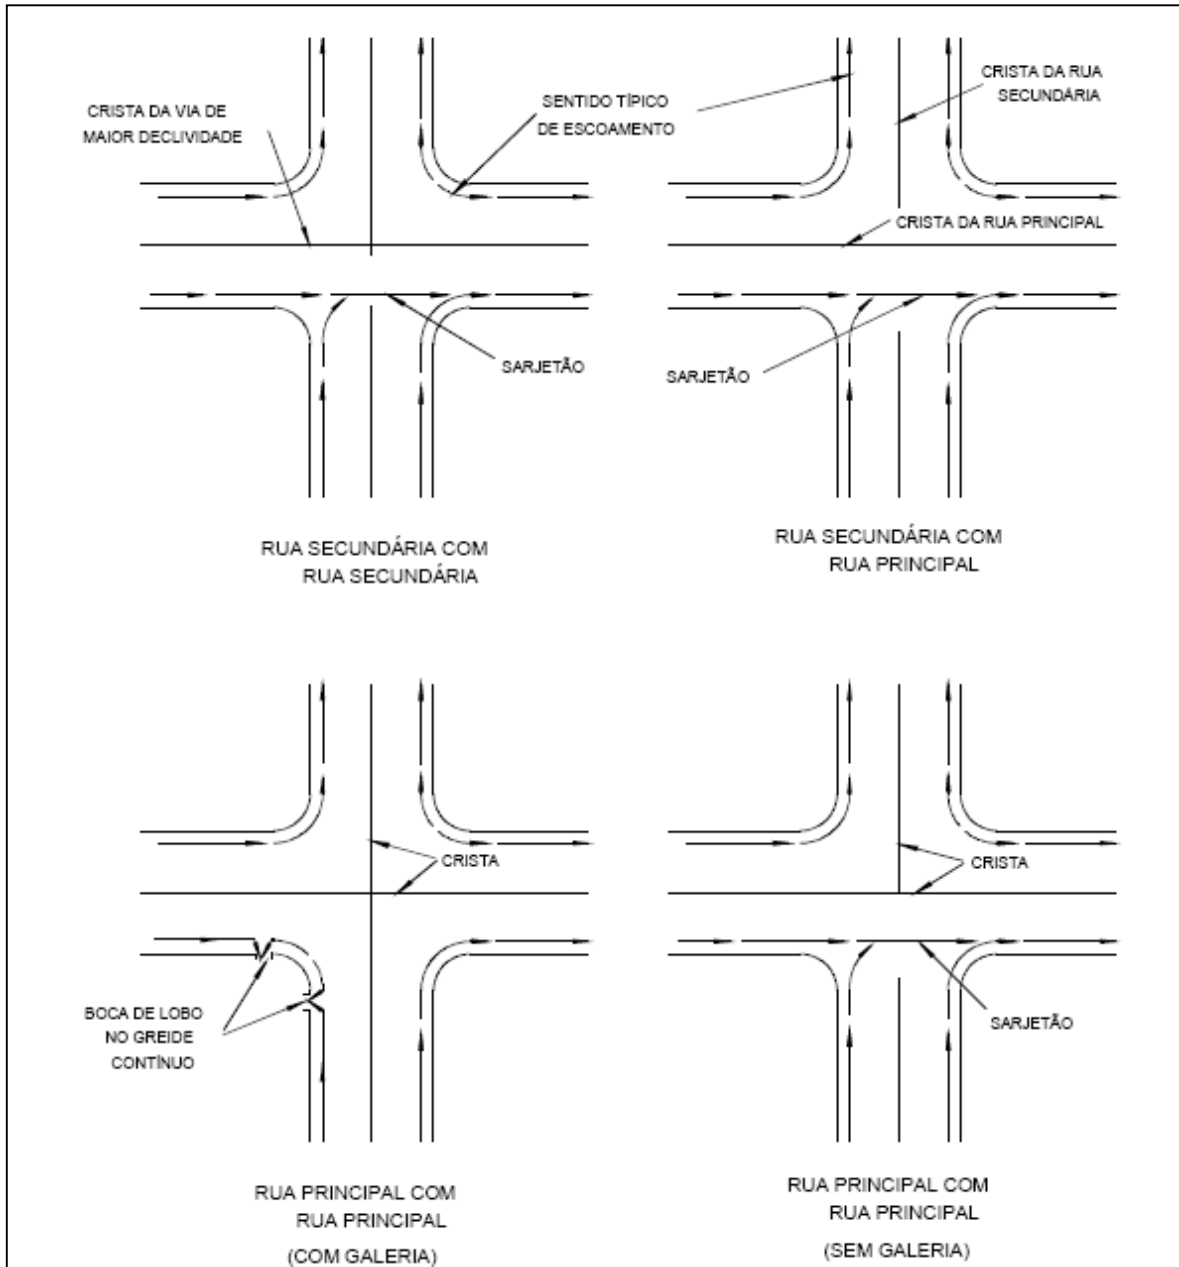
Configurações Típicas de Cruzamento em Sistema de Drenagem
